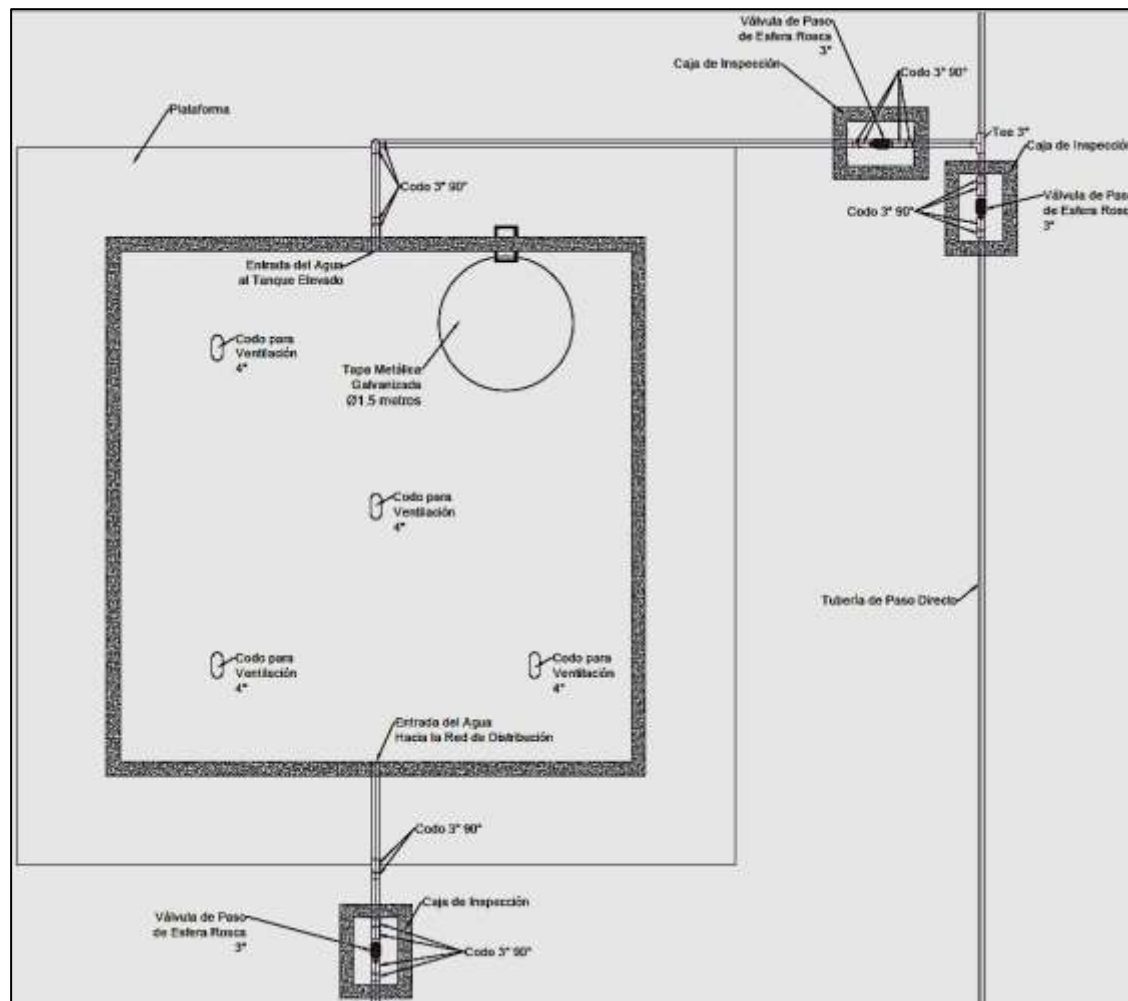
Vista en planta del tanque elevado de regulación. Fuente: Elaboración propia.
